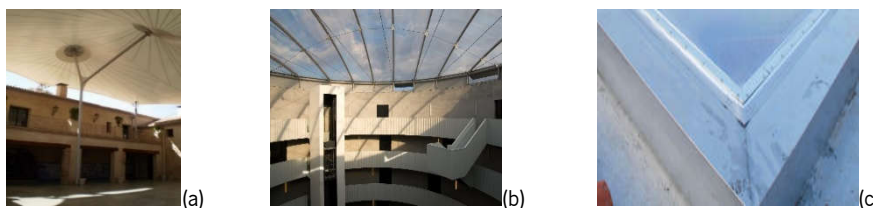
Exemplos de pormenores de ligações nos diferentes tipos de transmissão de carga em análise: (a) Pontual – exemplo projeto refª C.13; (b) Linear – exemplo projeto refª C.25; (c) Perimetral – exemplo projeto refª C.03.
